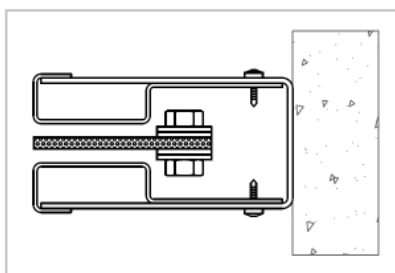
Монтаж на управляваща конструкция на вертикална стена/конструкция
